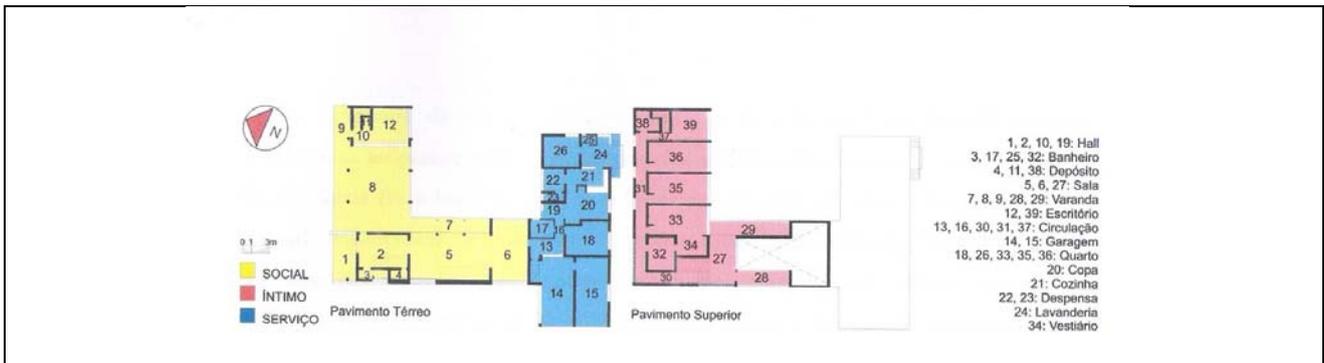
Casa Dr. Zenon Rocha – planta baixa. Fonte: Andrade (2005, 41)
